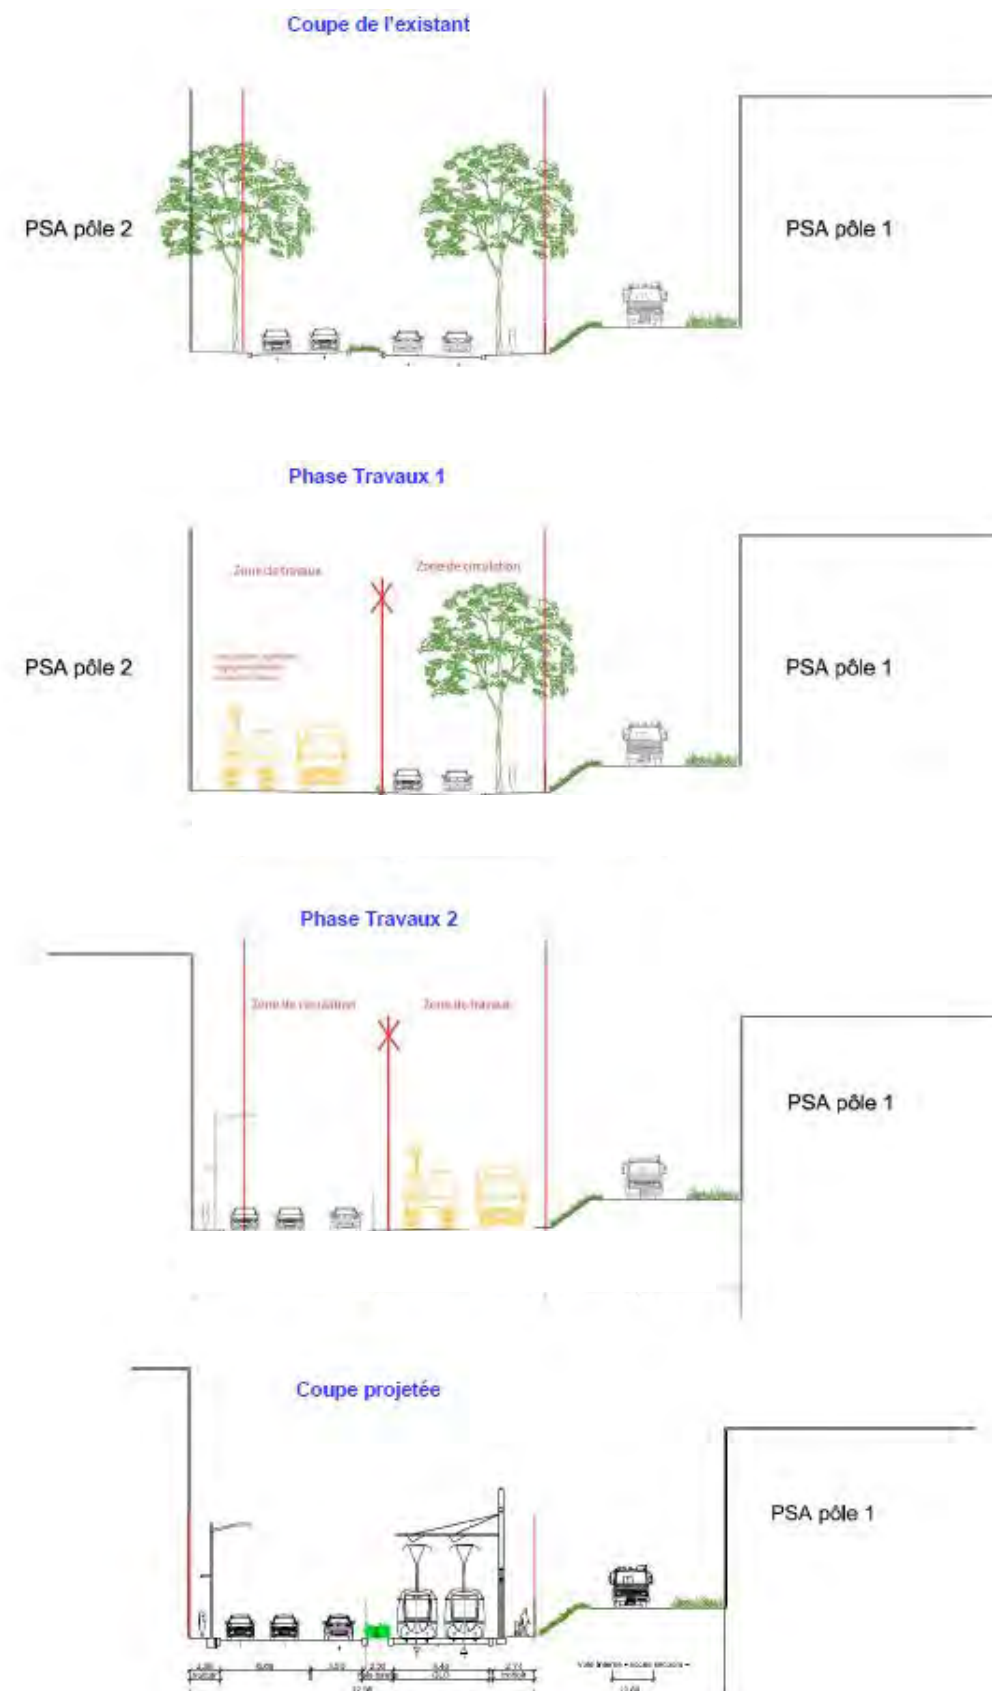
Principe de phasage sur le boulevard de l'Europe (section existante)
